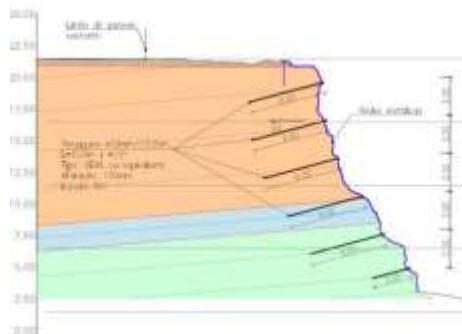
Corte Tipo e exemplo de aplicação de rede metálica pregada
